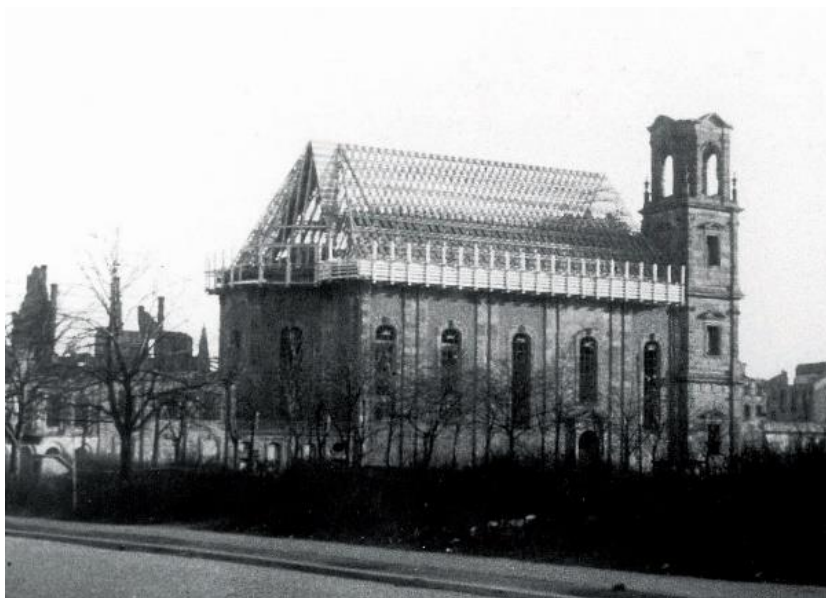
Pfarrkirche St. Peter mit neuem Dachstuhl, 1949
